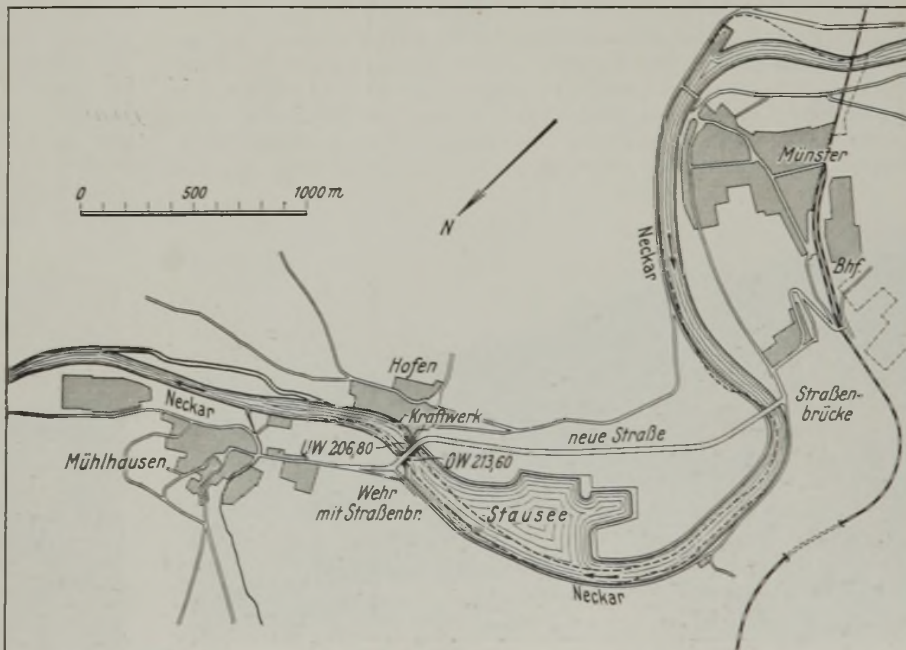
Staustufe Münster. 2. Bauteil. Übersichtsplan.
